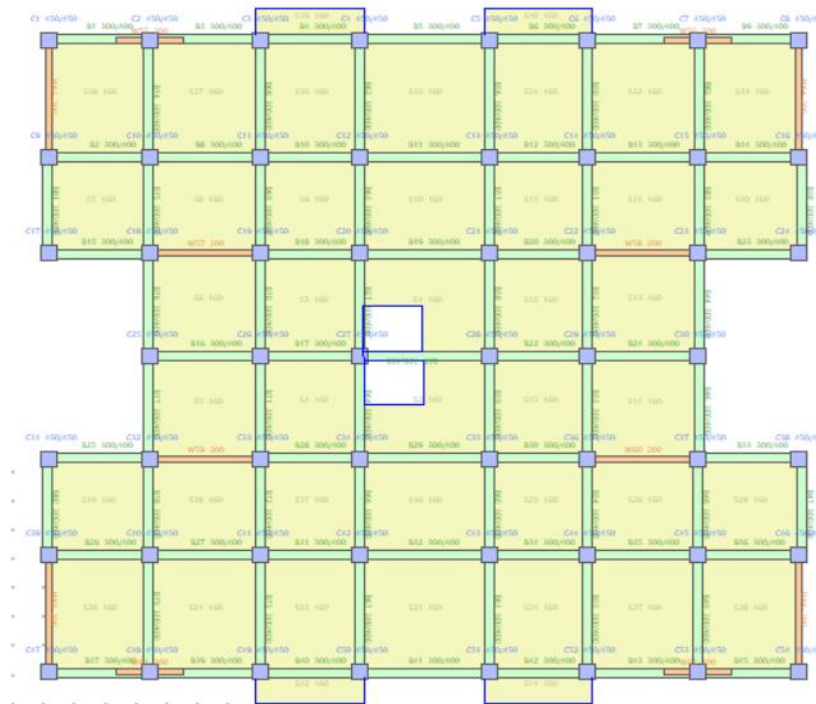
Plan en vue de dessus du niveau 1 de la structure à appuis fixes
